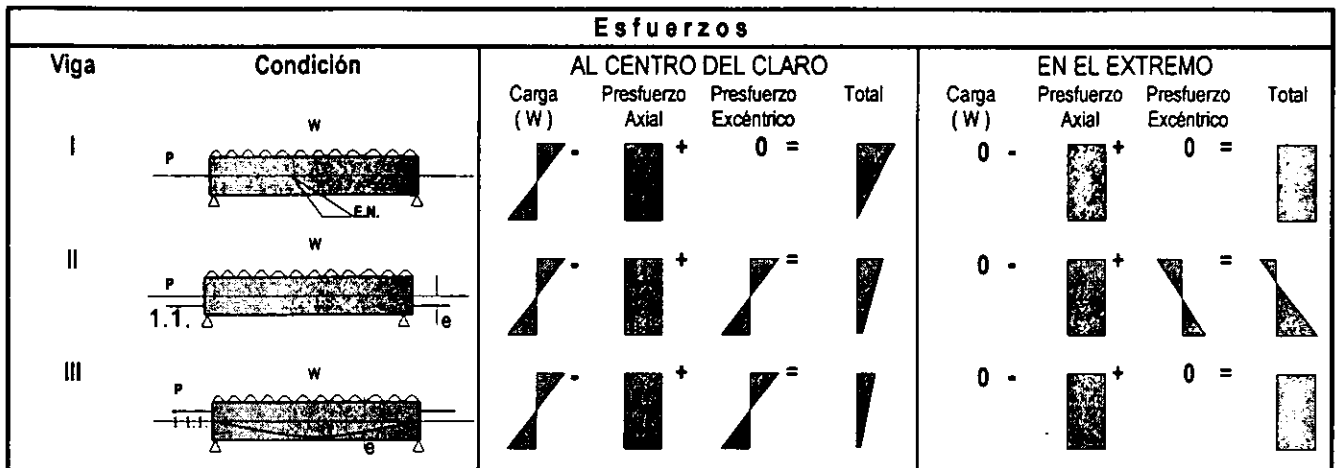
Esfuerzos al centro del claro y en los extremos de vigas simplemente apoyadas con y sin excéntrica.
